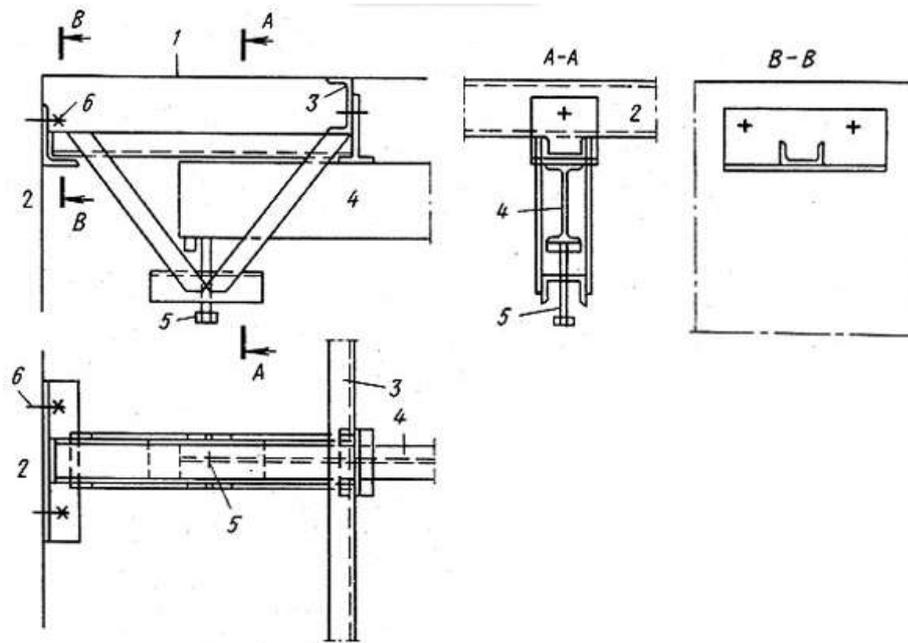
Усиление балочного перекрытия с помощью стальной колоды:
